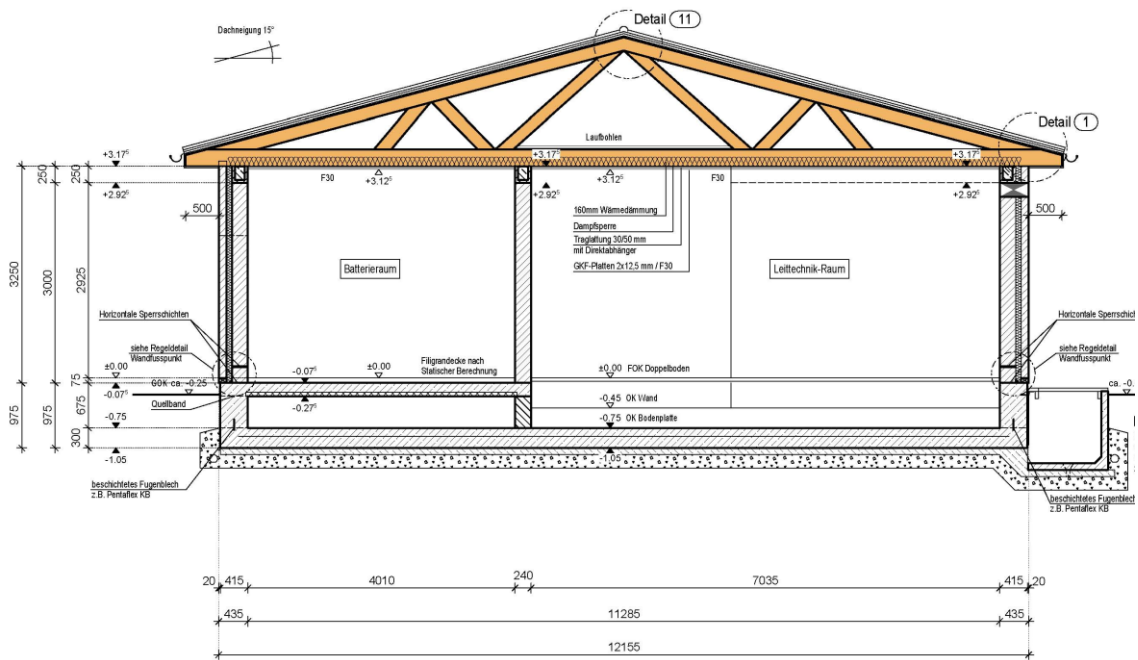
Geplantes Betriebsgebäude (Seitenansicht)
